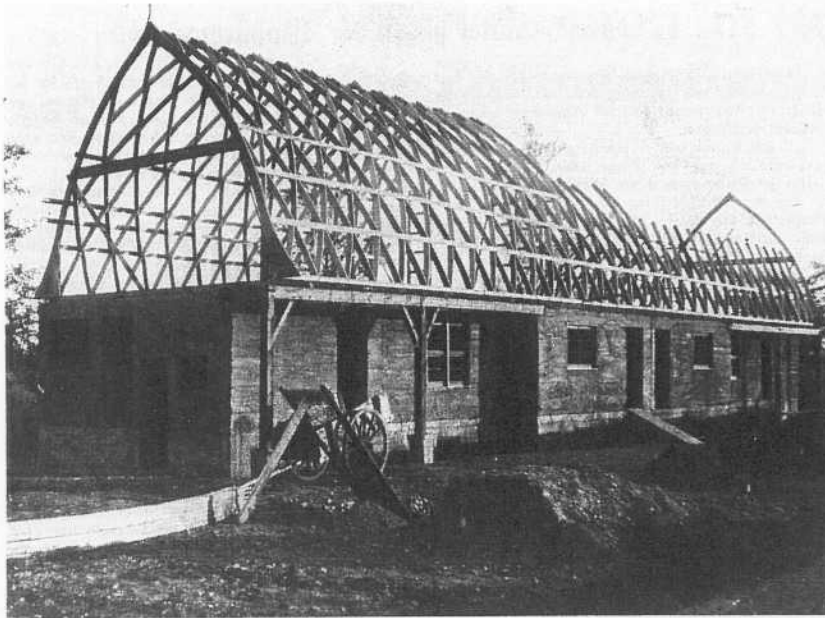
Doppelhaus mit Zollbau-Lamellen-Dach im Bau (Gensaer Straße, Merseburg 1922)
